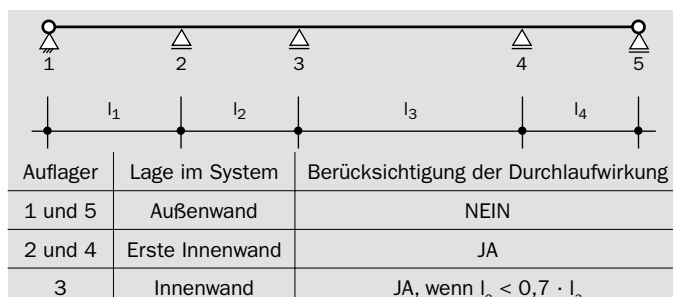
/1: Ermittlung der Deckenauflegerkräfte bei einachsig gespannten Decken
